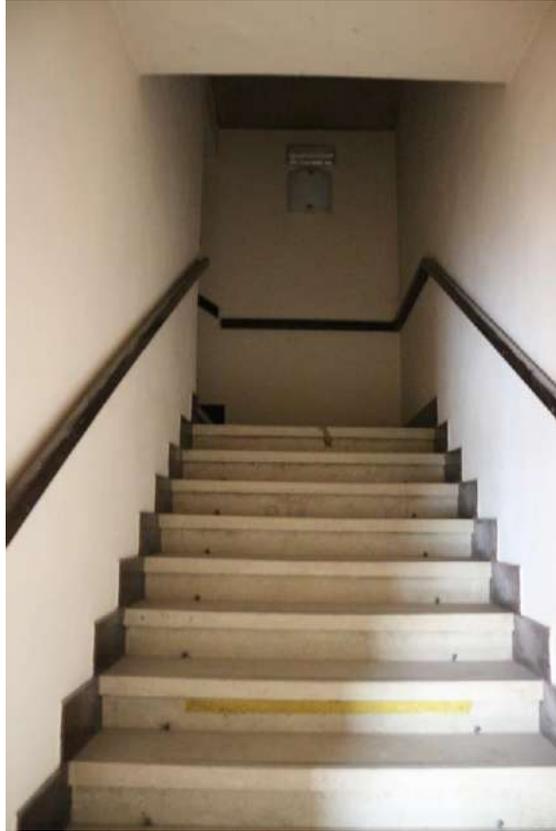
visione scala di accesso al piano primo – LOTTO 9.3
